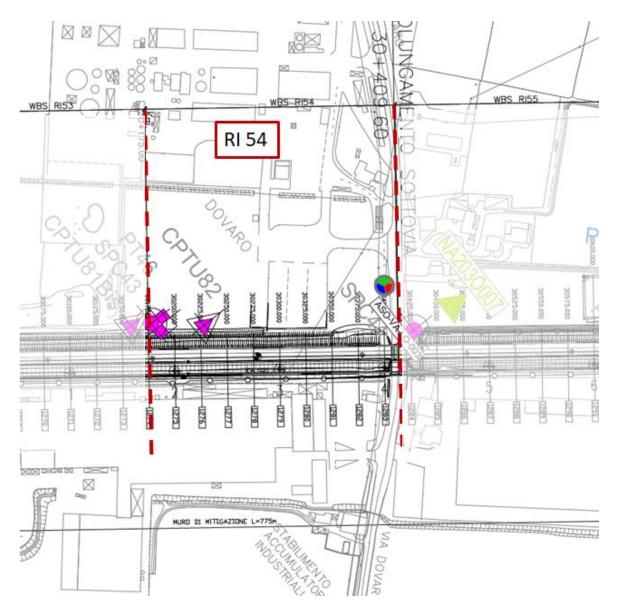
Planimetria Rilevato RI54, estratto dalla Planimetria Generale (Doc. Rif. [3])
